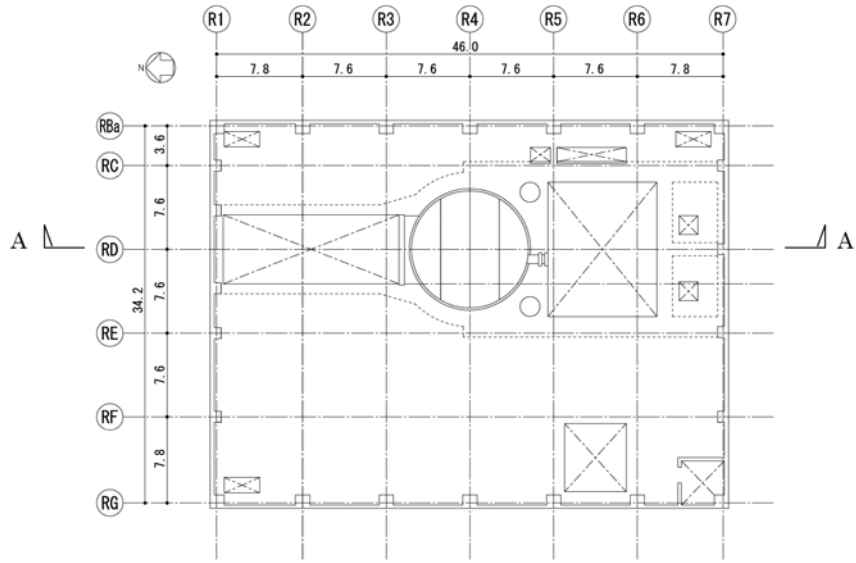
5階 (OP 39.92) 平面図 (単位 : m)
